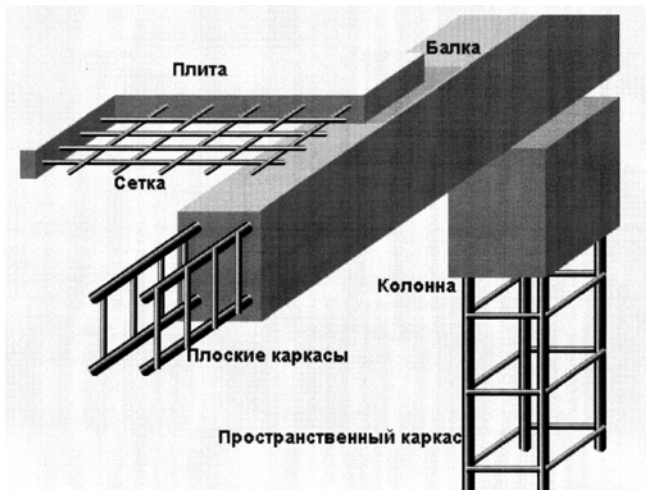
Конструктивные схемы арматуры железобетонных элементов
